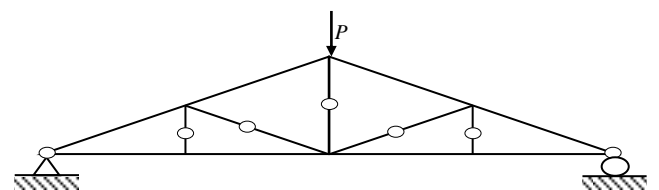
Poutre avec plusieurs barres non sollicitées
